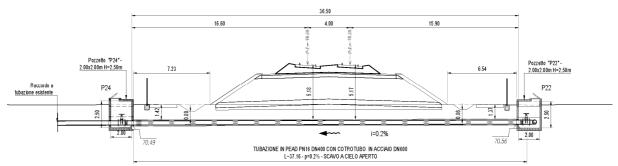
Attraversamento pk 9+825 – Sezione Trasversale
